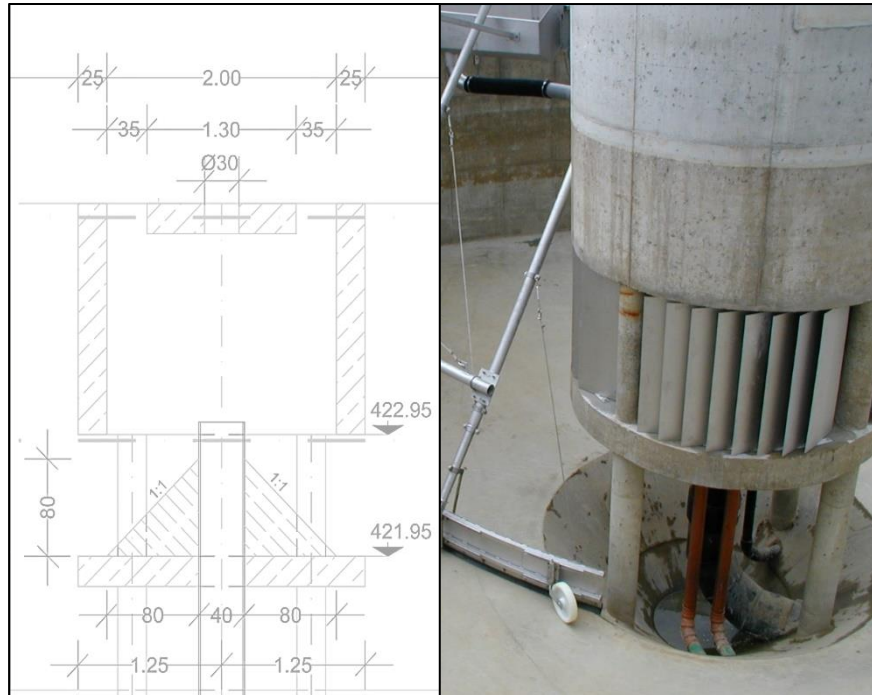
Bestehende Ausführung des Mittelbauwerks im Nachklärbecken
